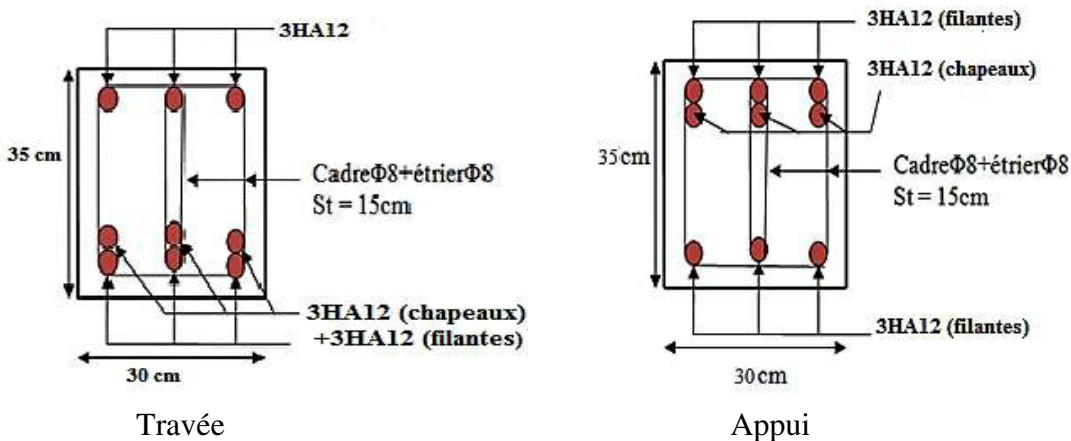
Schéma de ferrailage des poutres secondaires de terrasse.
